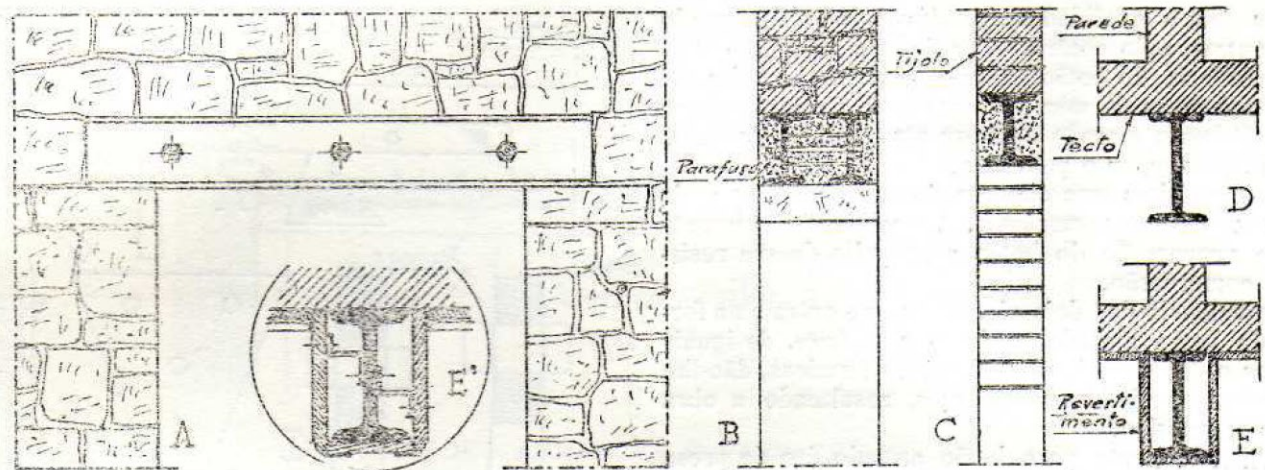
ASSENTAMENTO DE VIGAS DE FERRO
